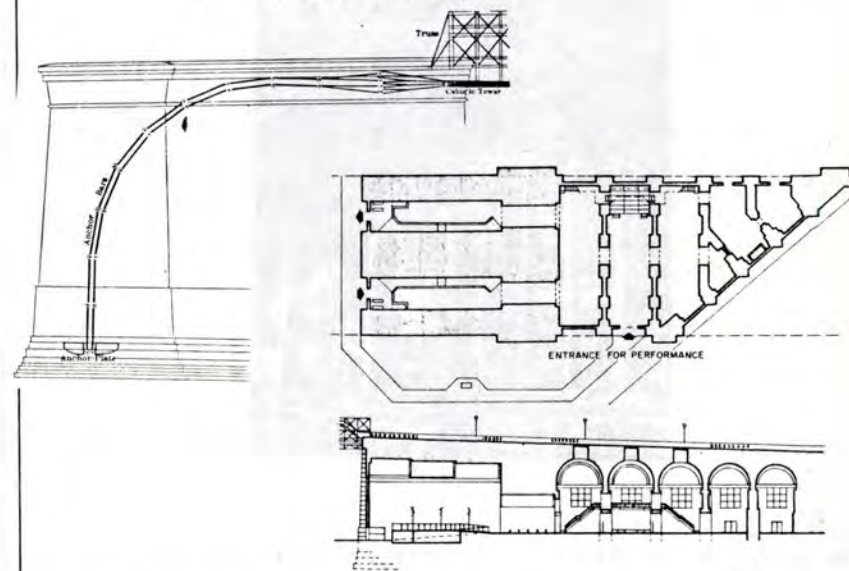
Pont de Brooklyn, New York (J.A. Roebling & W. Roebling, 1869-1883). Longitud total: 1052 m. Llum entre suports: 486 m. Els blocs d'ancoratge de 27 m. x 36 m. x 40 m. són de maçoneria de granit i pedra calcària sobre plaques de fundició (M. Shapiro, 1983, "A Picture History of the Brooklyn Bridge", Dover Publications Inc., New York)
